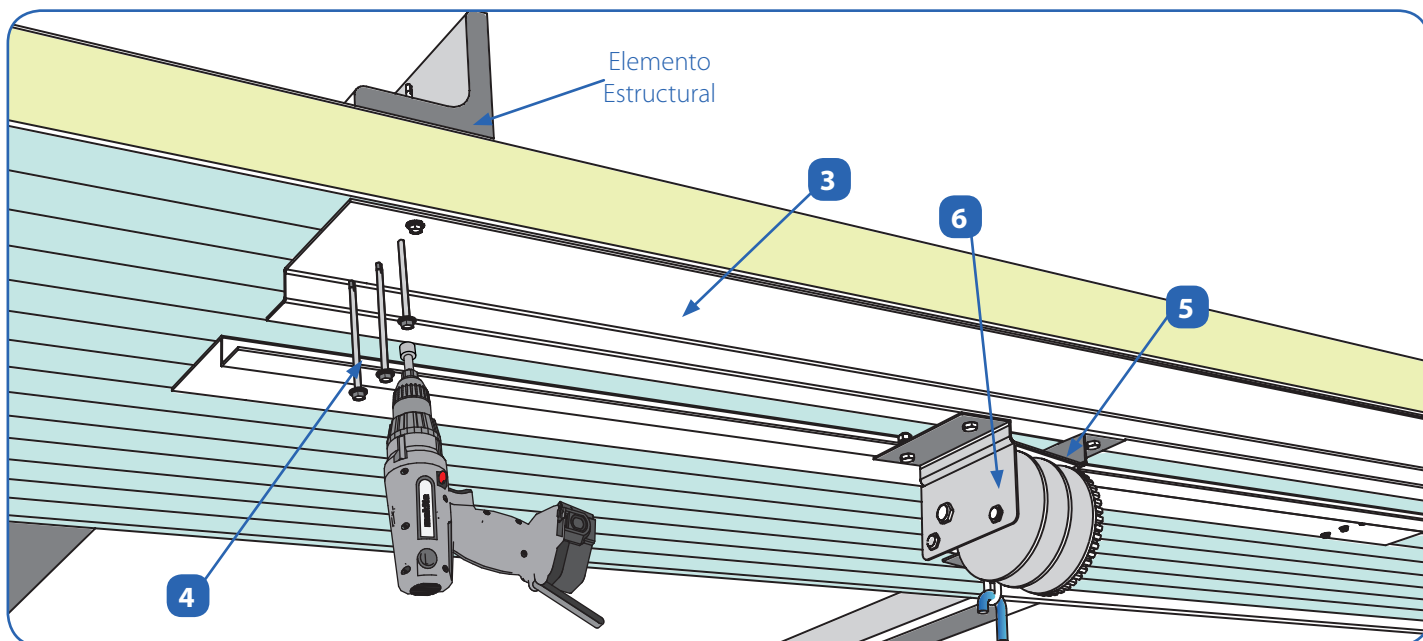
Zona de anclaje del soporte torno en la cubierta. Taladro para la colocación del torno en la cubierta, anclándolo a elementos estructurales.
